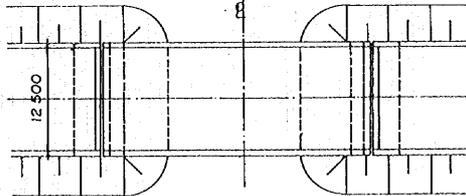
Plano Típico del Puente de Viga Simple de CP
